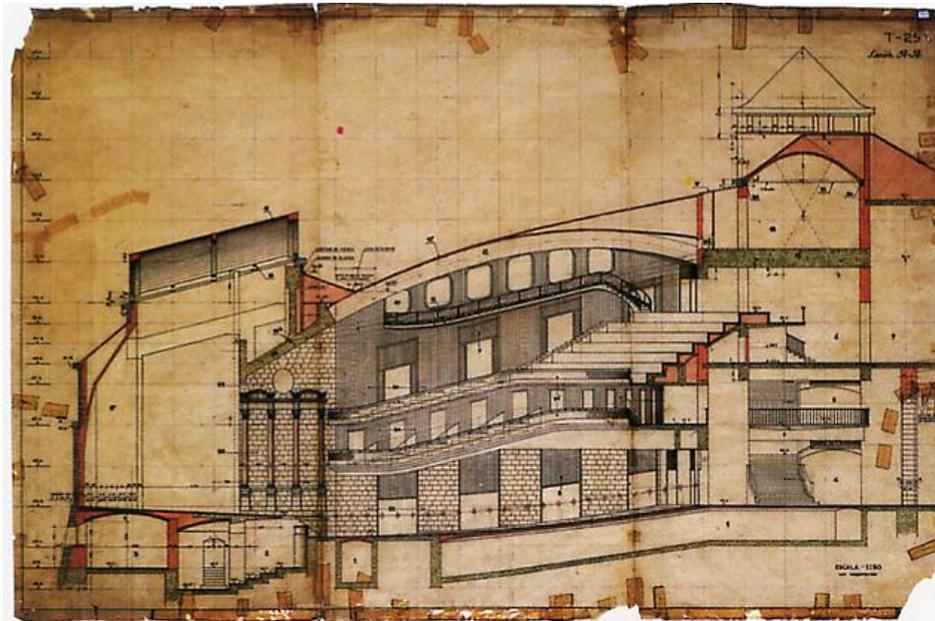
Plano del Proyecto Original con la Sección Transversal por el eje de la Sala.
